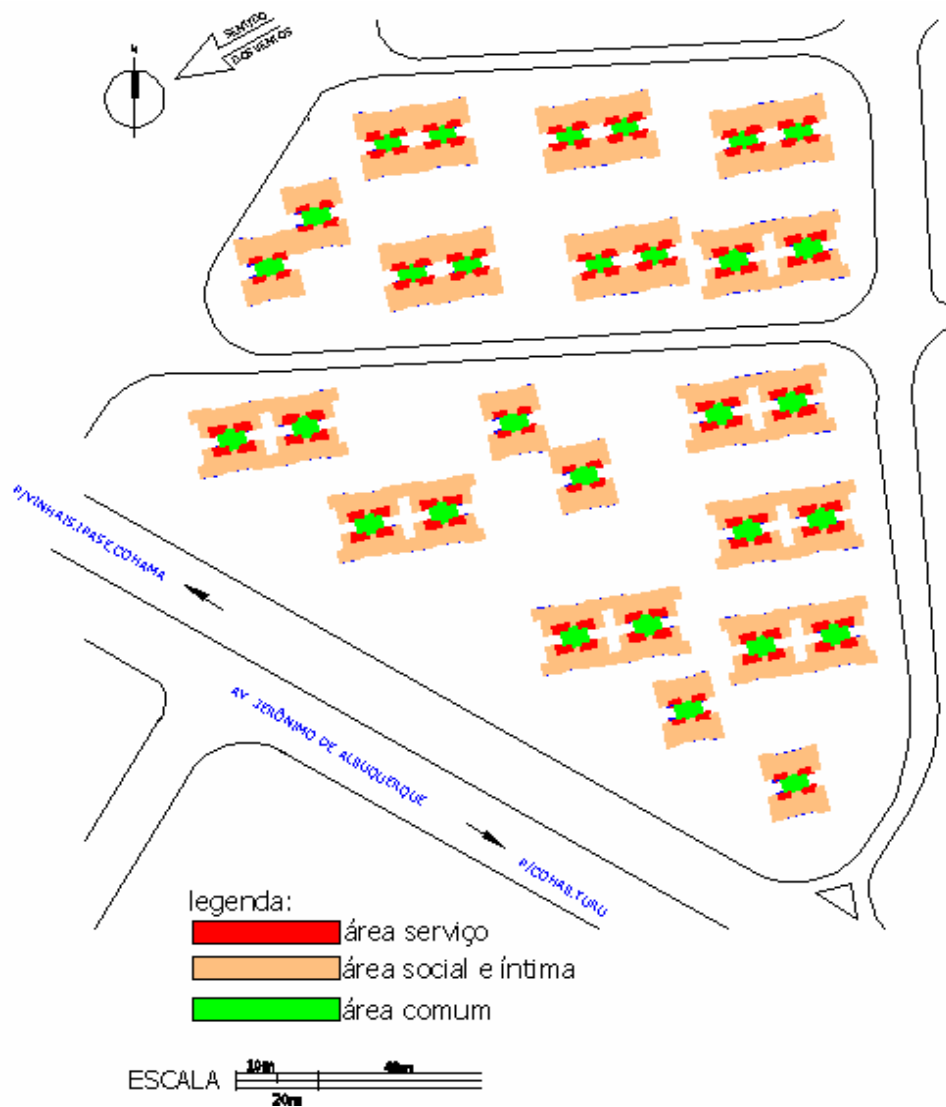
Planta de Implantação do Conjunto Ipem Angelim
